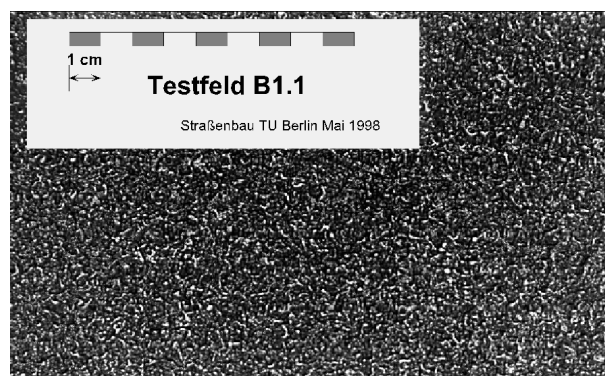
Oberfläche einer Betondeckschicht mit Möbelschleifband behandelt [7]
